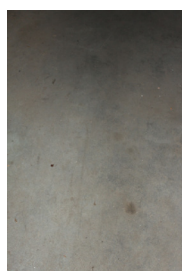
Pavimento de betonilha afagada na Casa da Tulha
